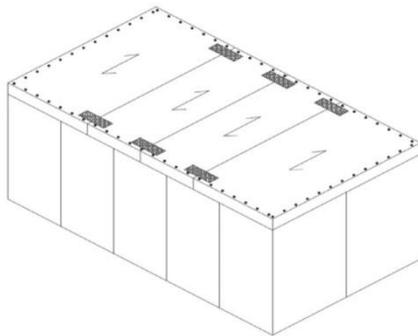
Exemple de chaînage par plaque métallique perforée
